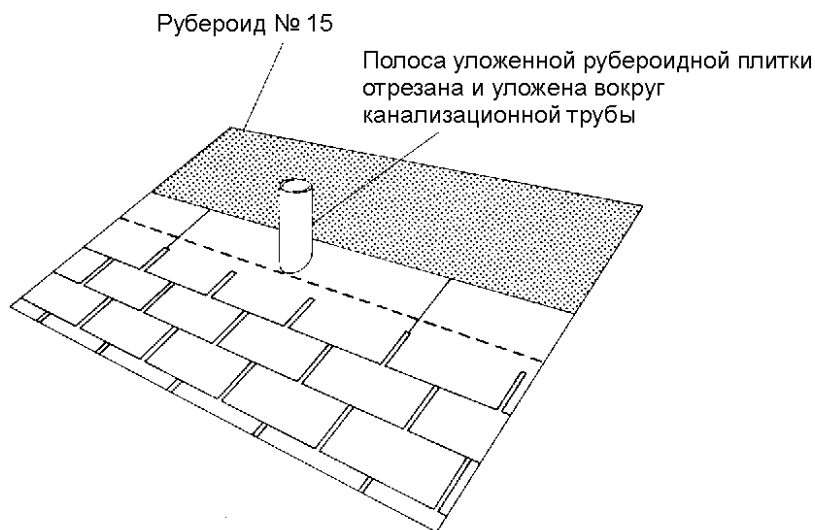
Кровля укладывается до вентиляционной трубы, а затем вокруг нее (Bird and Son)
